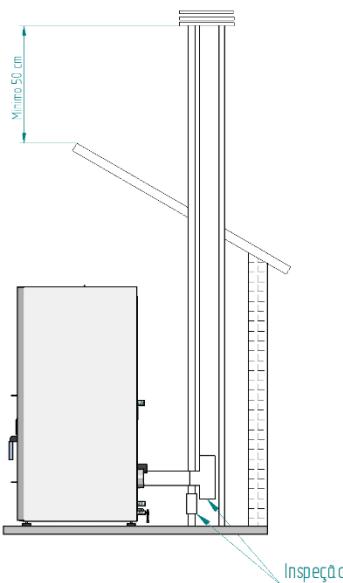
Vista lateral da instalação com chaminé, com exemplo do ponto de inspecção.
